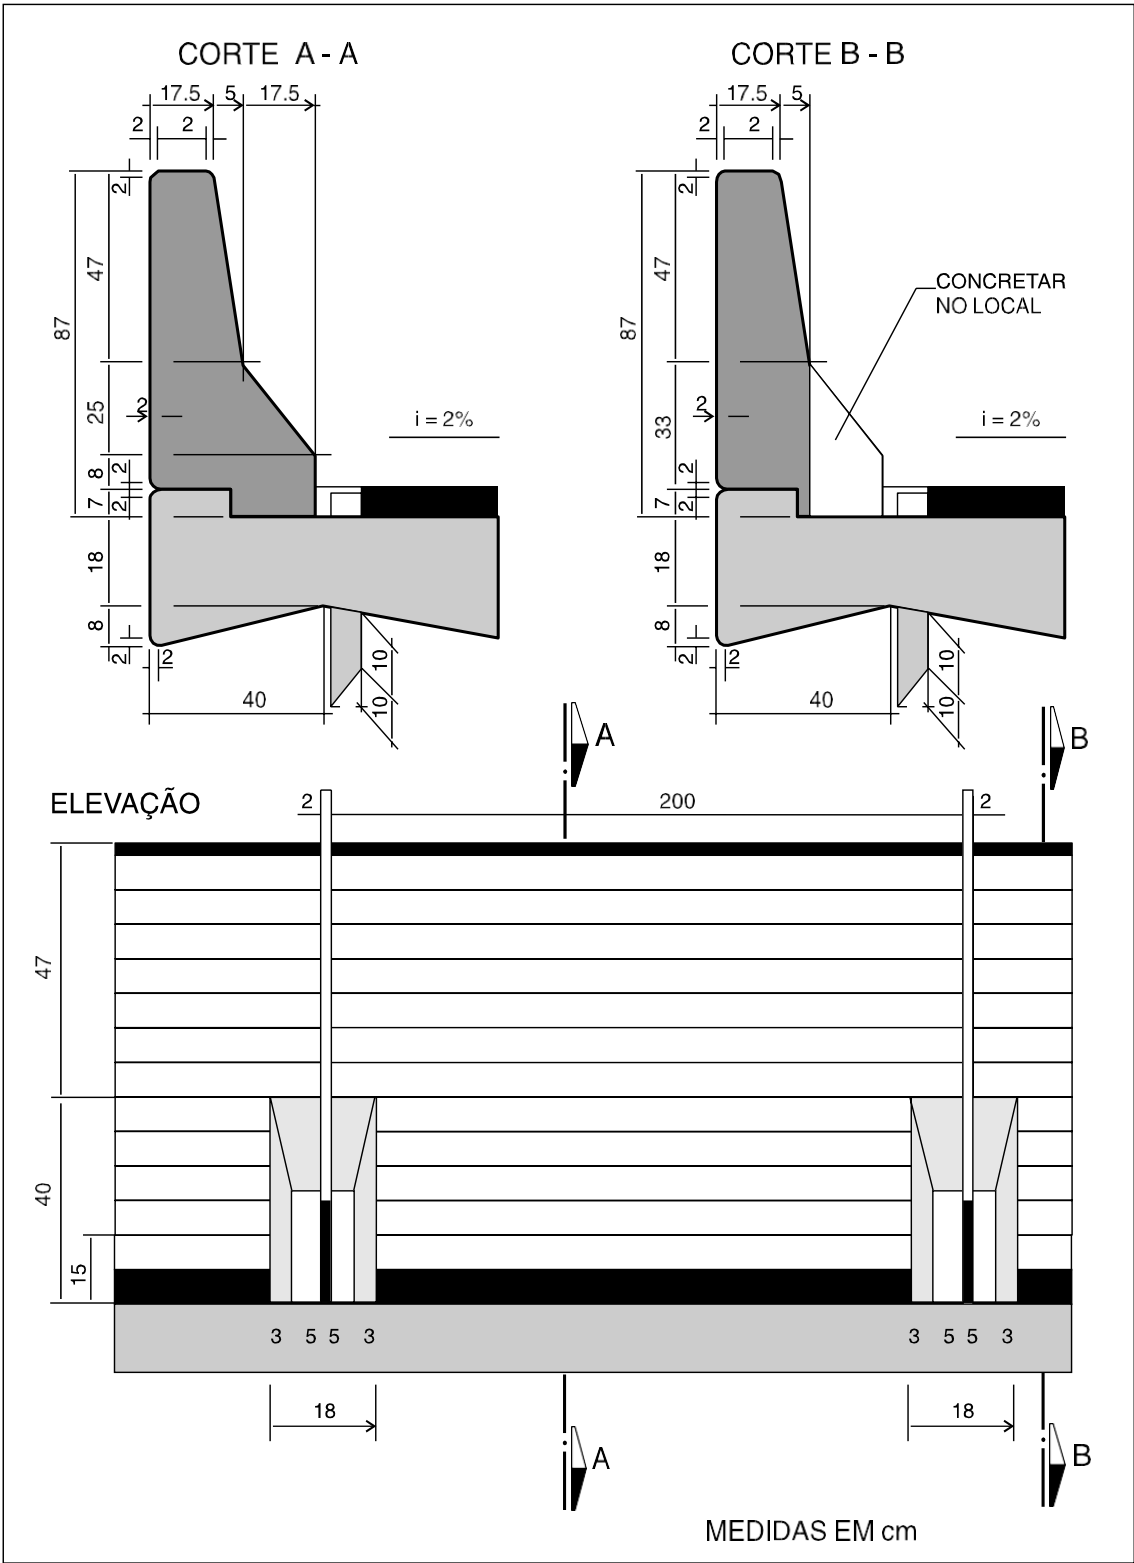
DETALHE DA BARREIRA PRÉ-MOLDADA
